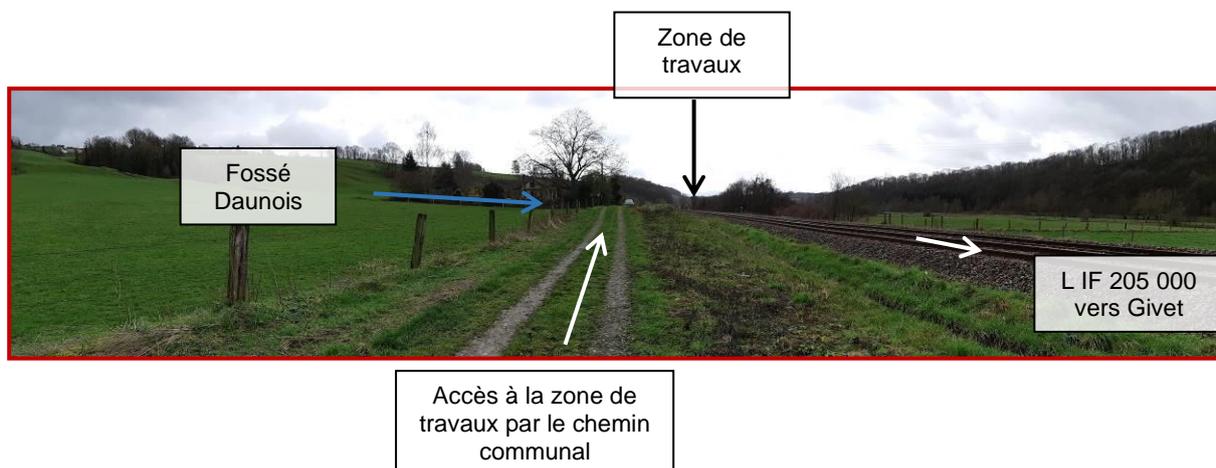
/02/2020 : accès à la zone des travaux depuis l'aire d'installation de chantier
